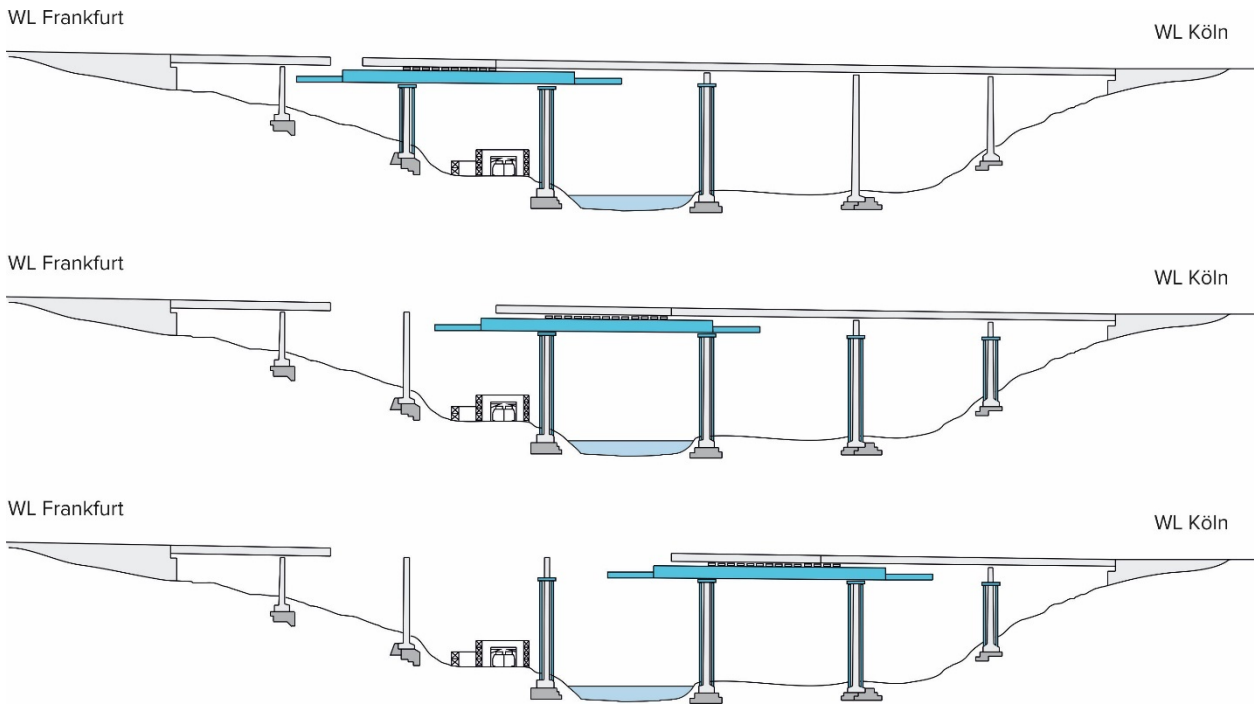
Rückbau der Lahtalbrücke Limburg mit Vorschubgerüst (© Gregor Schacht)
